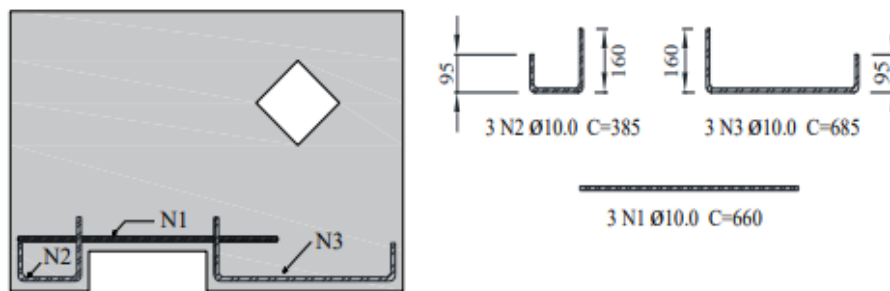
10 – Detalhamento das armaduras DB-NR-H1-NA (dimensões em mm). Neta (2019).
